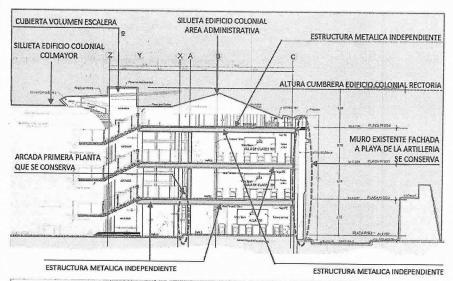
Concepto de contendor donde se aprecia que entre los muros preexistentes que confinan el bloque, se disponen los entrepisos de las nuevas aulas soportados con una estructura metálica independiente de estos muros. Fuente: elaboración propia.
